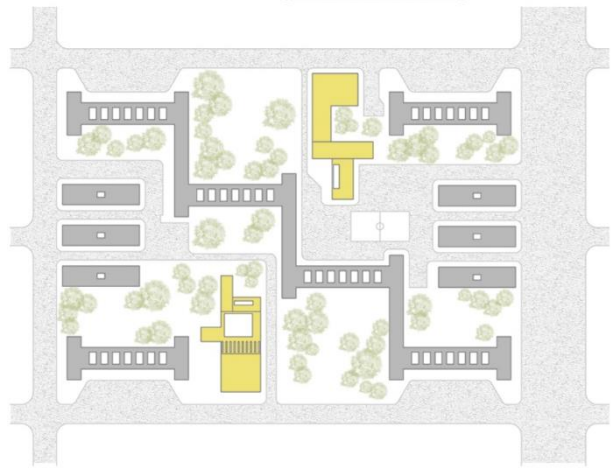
Plan general del Conjunto Urbano Presidente Alemán. Fuente: Archdaily
